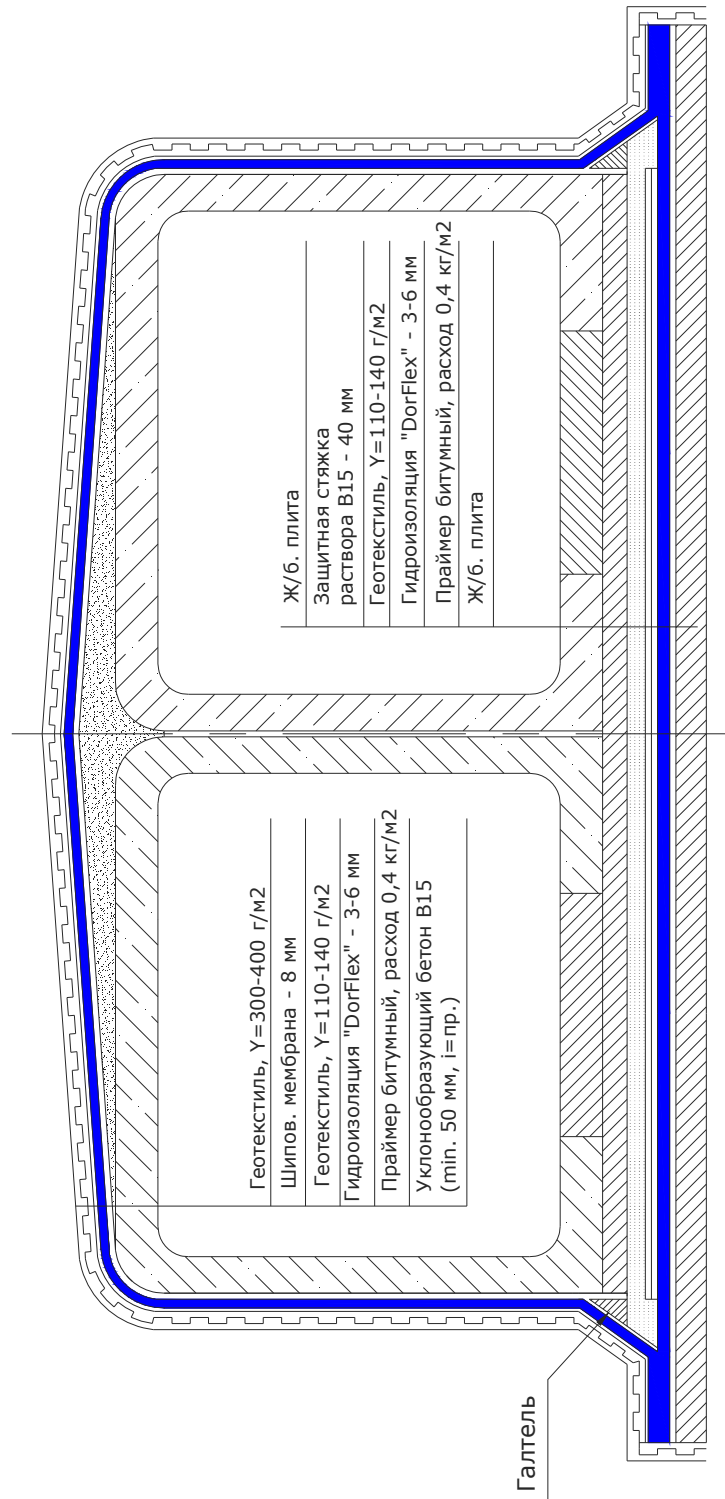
Внешняя гидроизоляция тоннеля.
